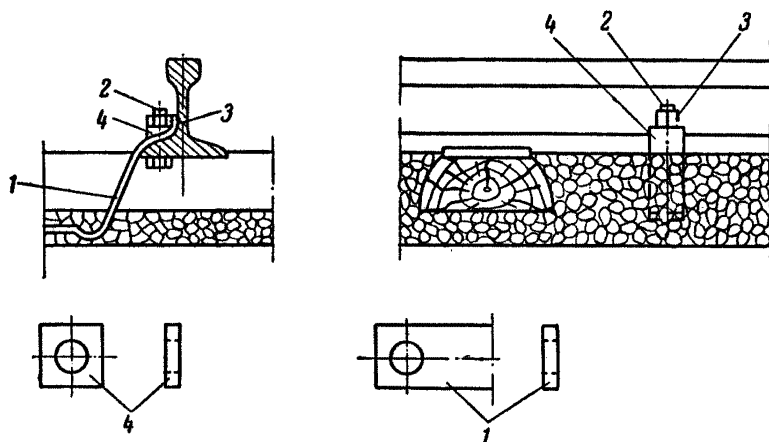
Соединение заземляющего проводника с подошвой рельса (болтовое соединение):
